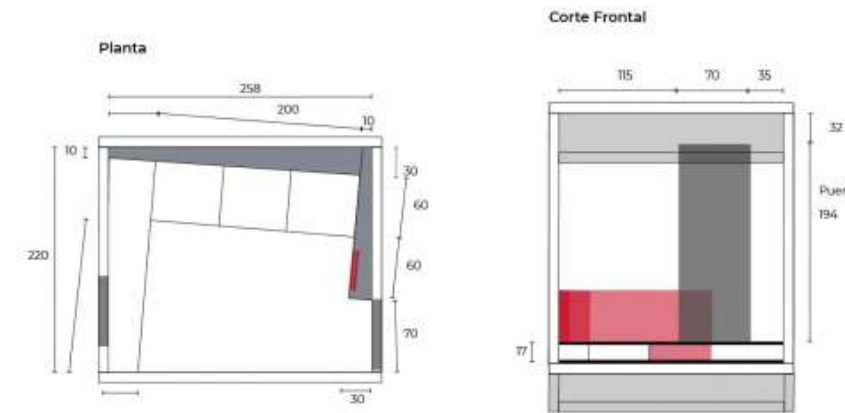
Esquema planta y corte frontal propuesta final. Elaboración propia.
